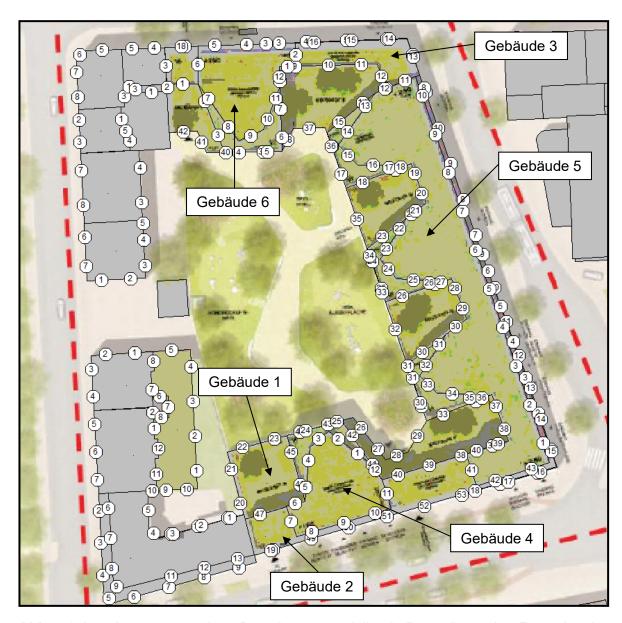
Auszug aus dem Berechnungsmodell mit Darstellung der Fassadenabschnitte der bestehenden und geplanten Gebäude
